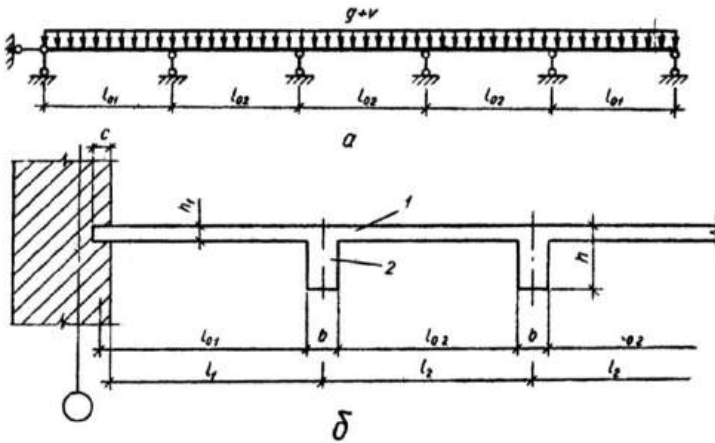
До розрахунку плити ребристого монолітного перекриття з балковими плитами: а – розрахункова схема; б – розрахункові прольоти; 1 – плита; 2 – другорядна балка
